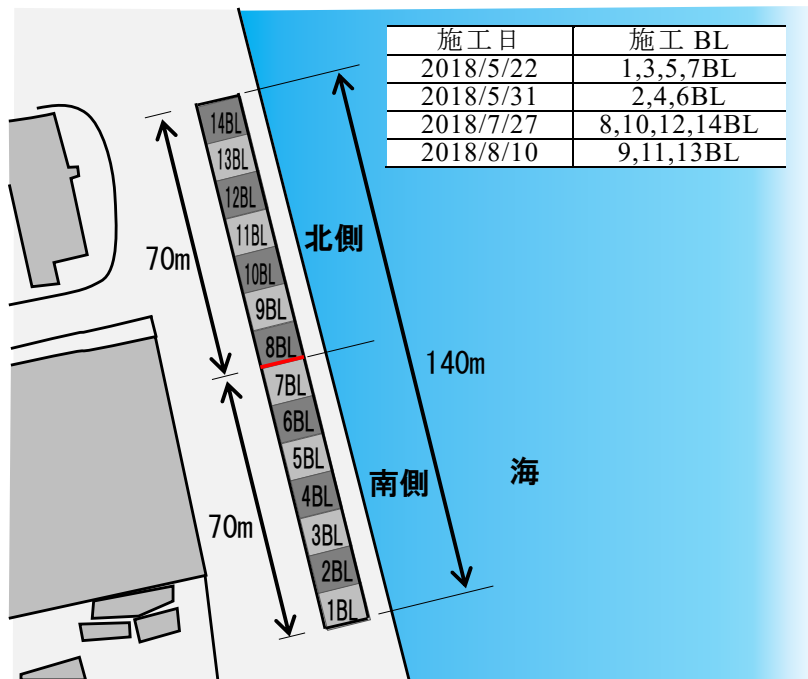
施工順序（平面図）およびコンクリートの打込み工程
